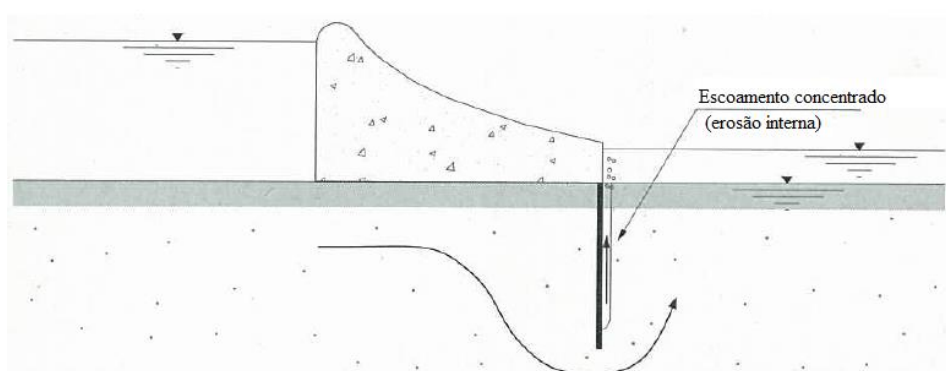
8 - Escoamento concentrado em galeria formada por erosão interna na interface terreno-barragem [7]
